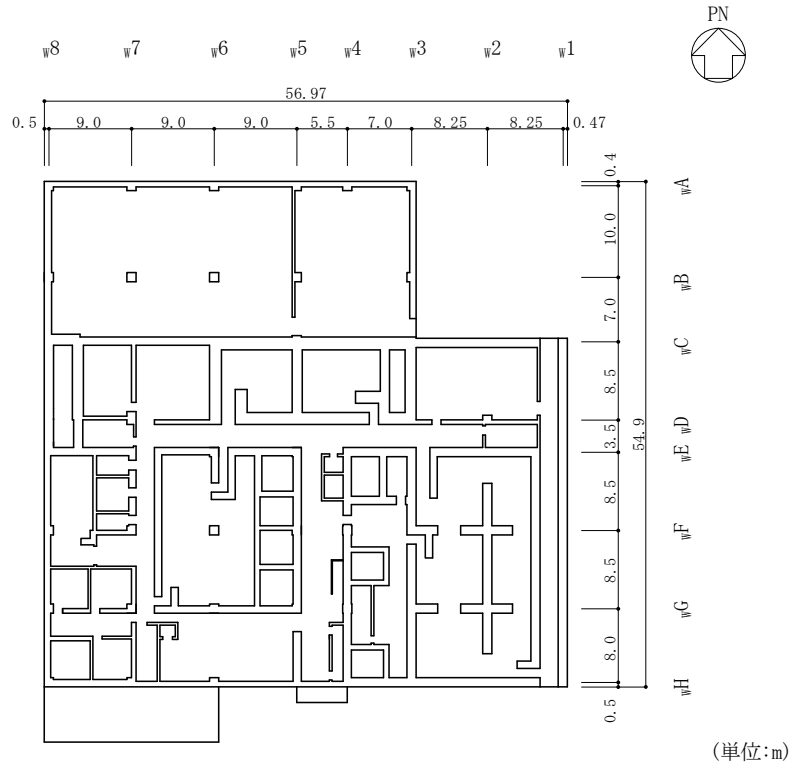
(5) 廃棄物処理建物の概略平面図 (EL 22.1m)
